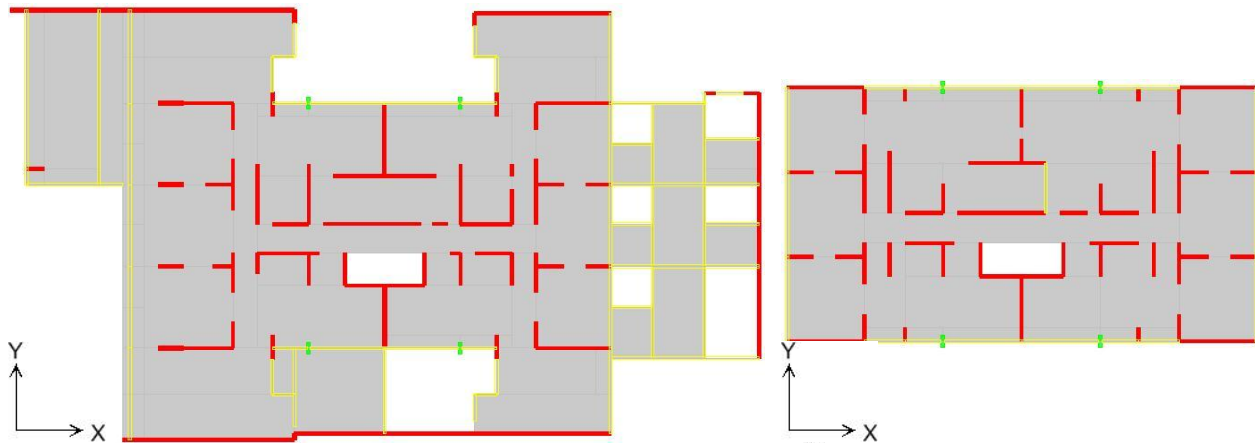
Planta primer piso (izquierda) y piso tipo (derecha) edificio H12
